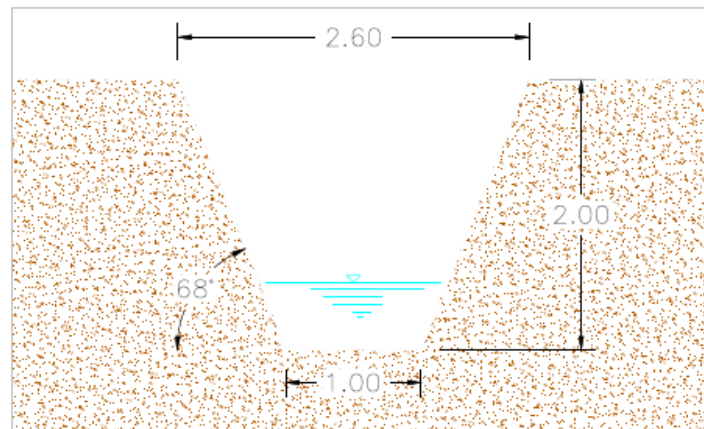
Canale di laminazione Gronda Ovest – Sezione tipo – Stralcio tavola progettuale
